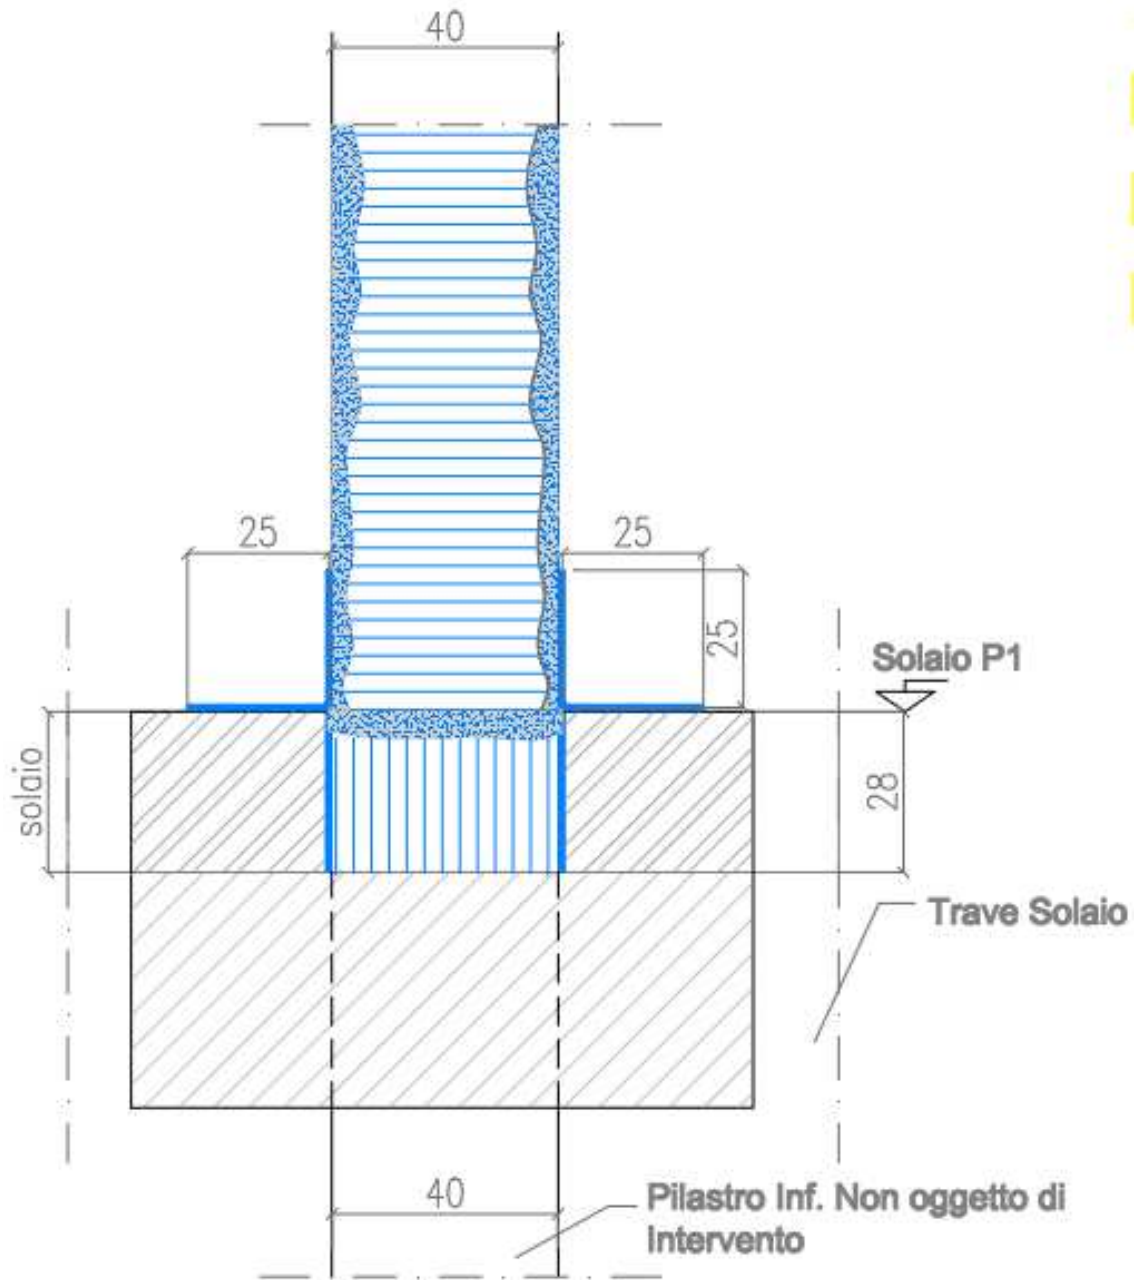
Prospetto tipo di rinforzo a taglio pilastro mediante FRP
